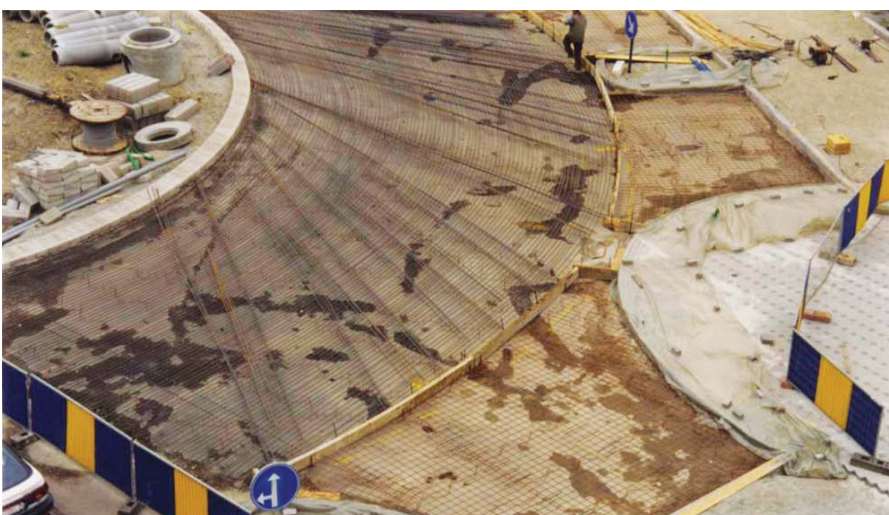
Giratoire en béton armé continu. Schéma de principe au niveau des dalles d'accès : dalles armées, dalles non armées, joints ancrés, joints goujonnés, ...
